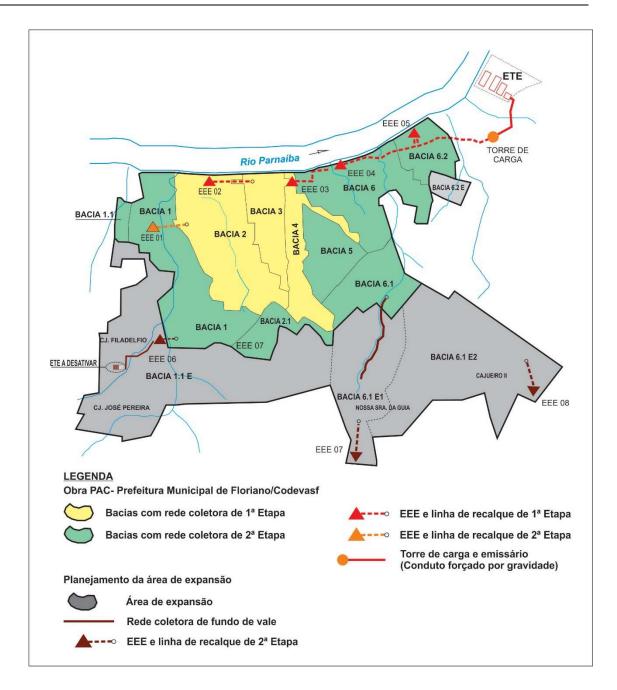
OBRAS A SEREM EXECUTADAS
